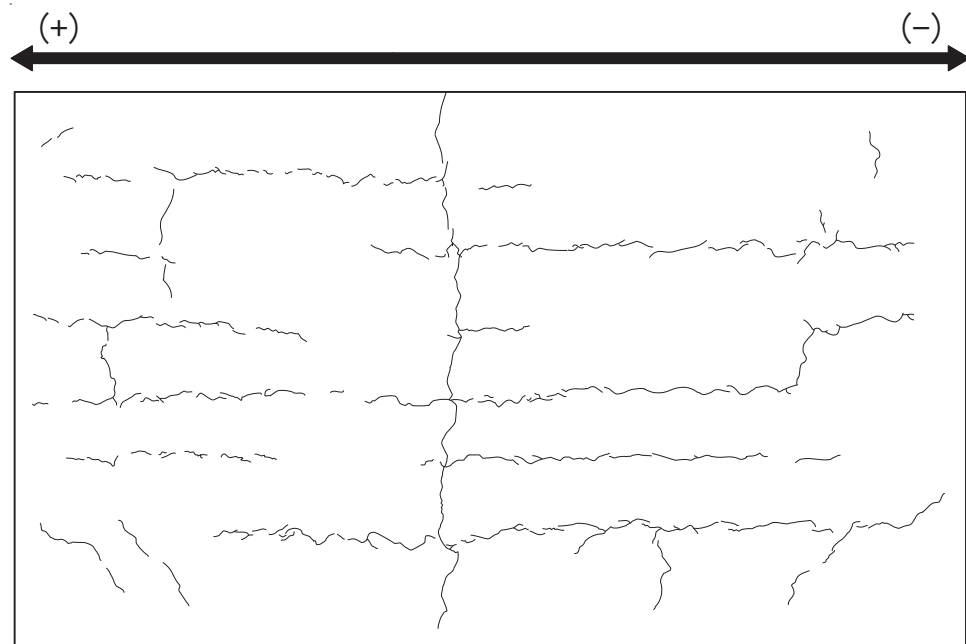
(1) 乾燥試験体 [1] 実験前ひび割れ状況
